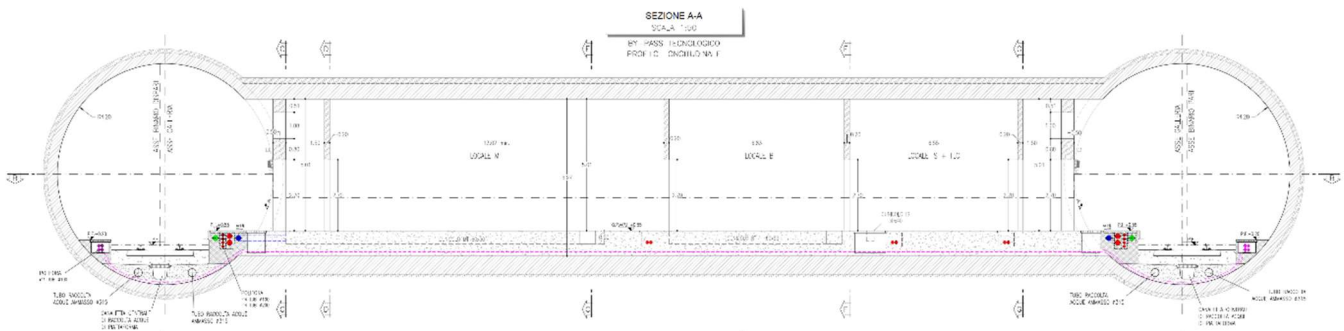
Bypass tecnologico tipo – Profilo longitudinale
